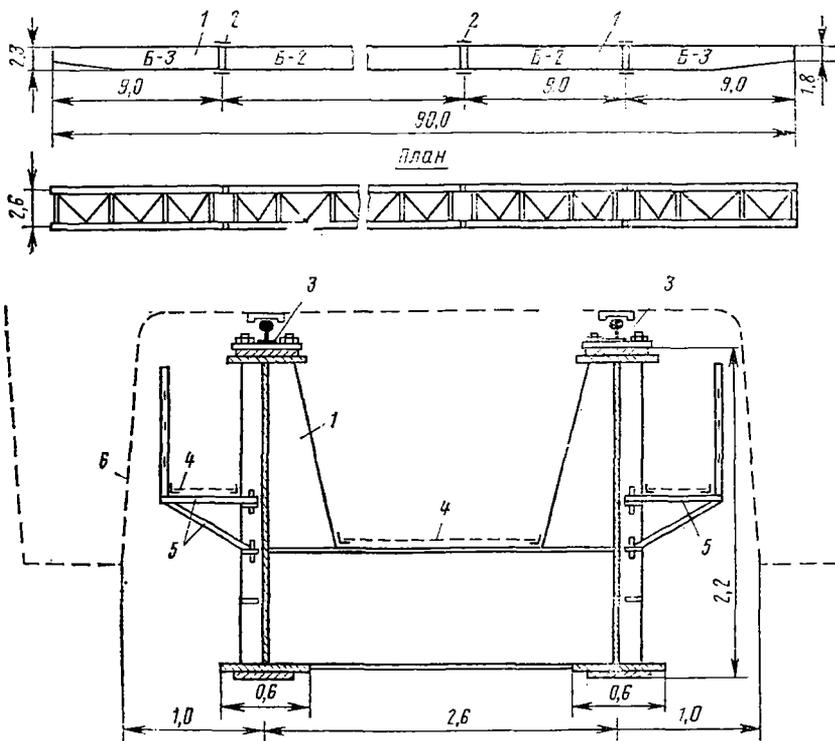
Схема и поперечный разрез перемещающихся металлических подмостей:
